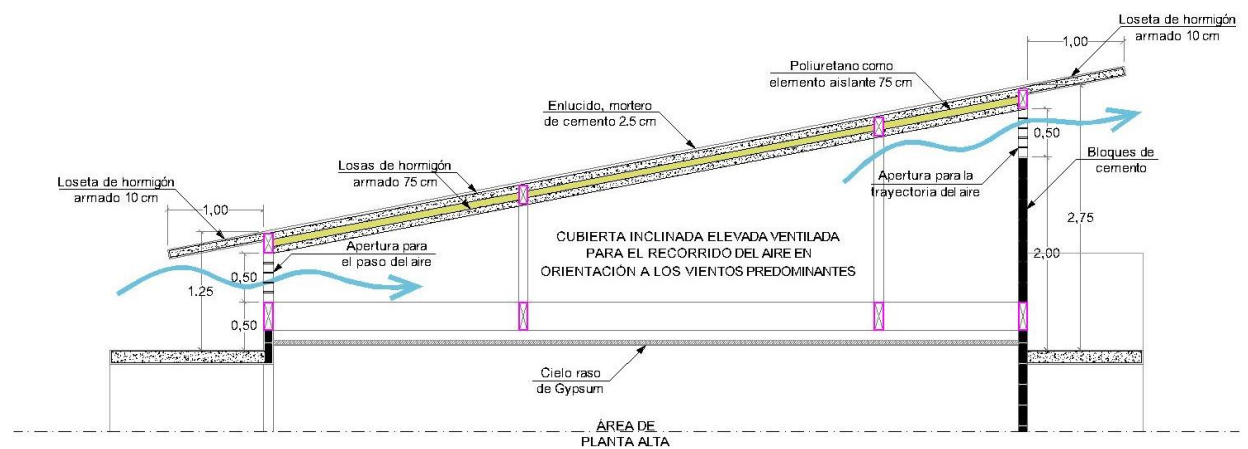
Cubierta inclinada ventilada del proyecto modificado. Elaboración Propia
